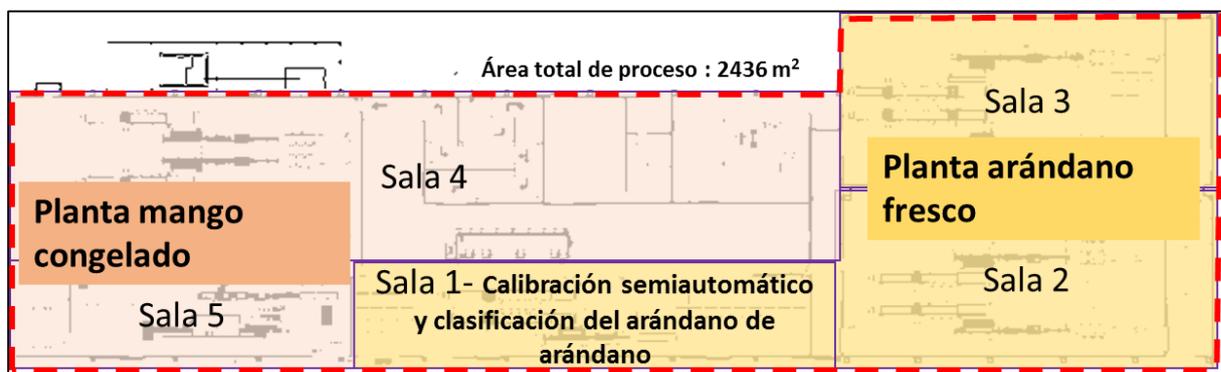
Layout actual de la planta de arándano fresco y de mango congelado
